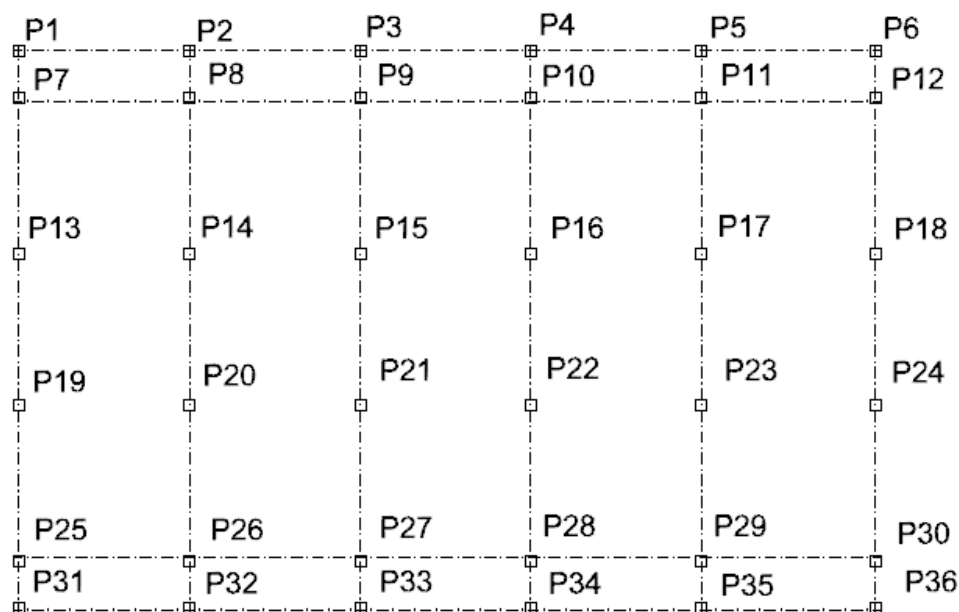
Pilares que suportam o pavimento do auditório
